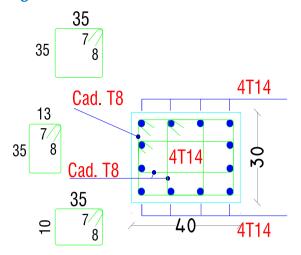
Ferraillage des poteaux (40×30) cm².
